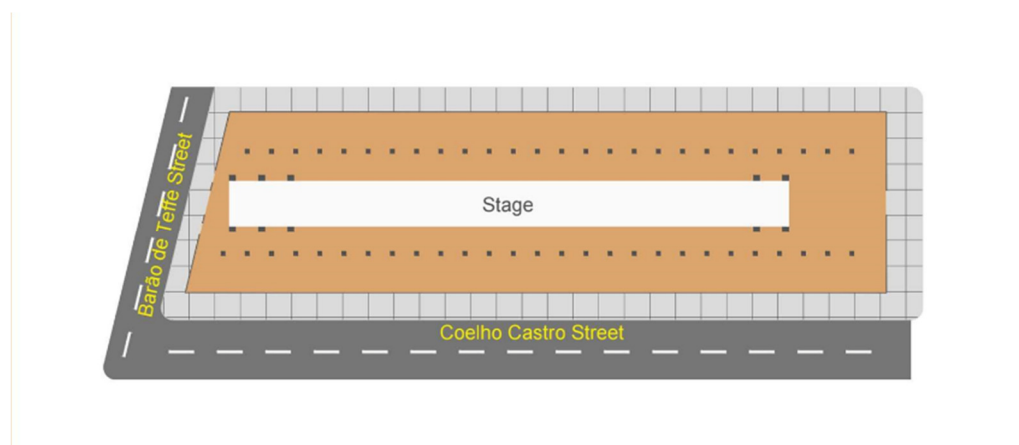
Galpão Docas D. Pedro II. Configuração de palco utilizada na montagem de 2007. Esquema da planta desenhado por João Marcos Lima, 2023.
